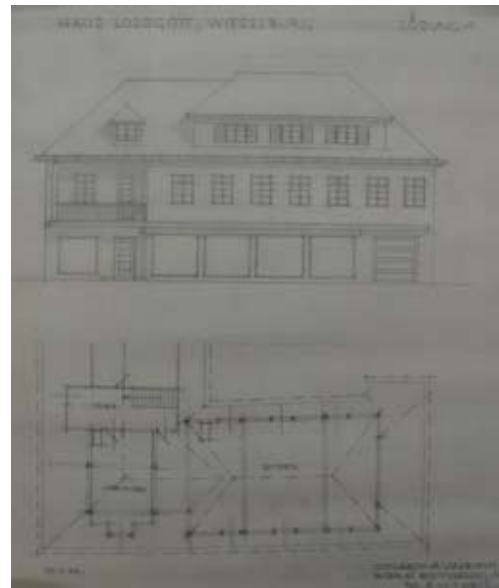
Plan 12.8: Anton Valentin. Haus Lossgott, Wieselburg. Lösung 1. Ansicht und Grundriss. 25. September 1930.
